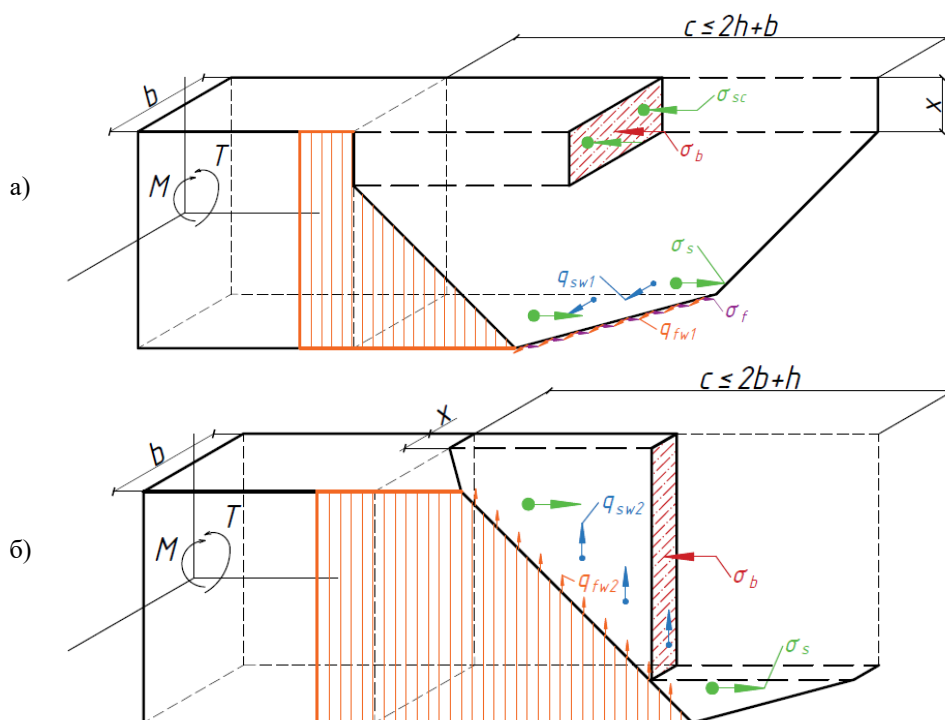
Схема распределения усилий, в пространственном сечении, железобетонного элемента, усиленного внешним композитным армированием по расчетным схемам: (а) I; (б) II (разработано авторами)
